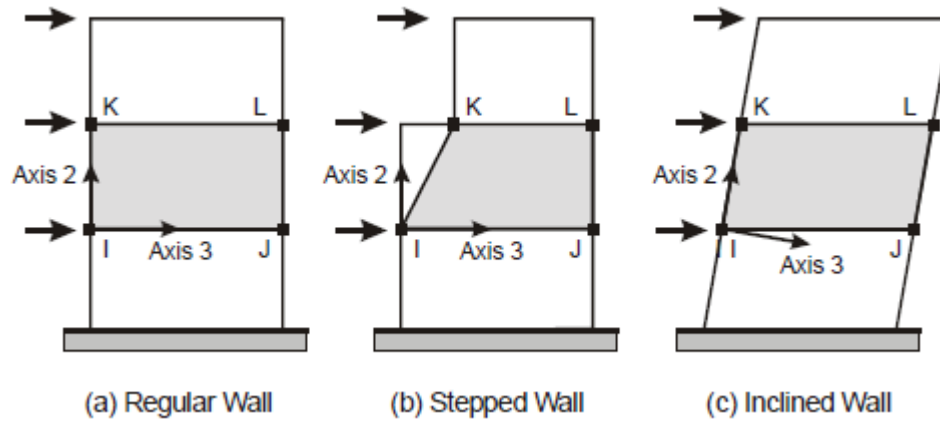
Elemento tipo muro de corte (Shear Wall Element). Perform 3D, Components and Elements, 2006 [5].
